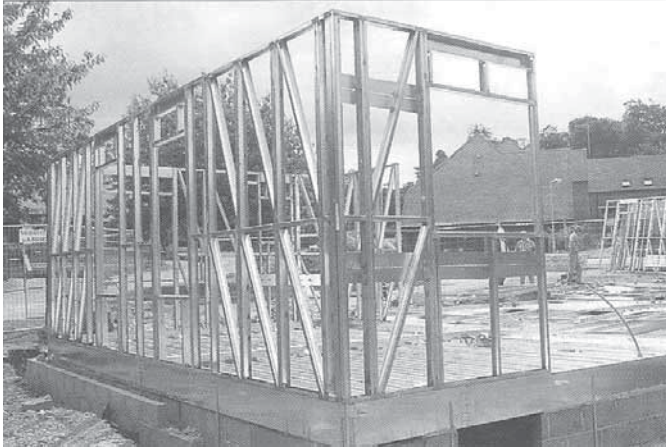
Contraventamento em "K" (fonte: SCI)
